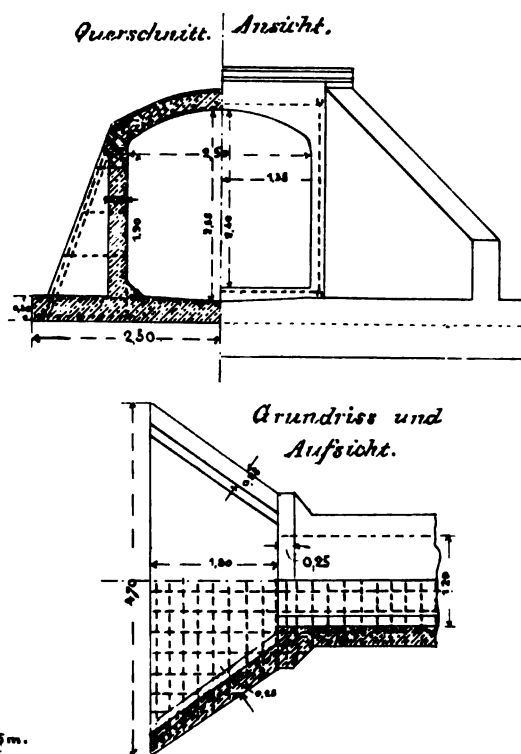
Entwurf einer Deichschleuse (Deichsiel) mit zweiflügligem Tor.
